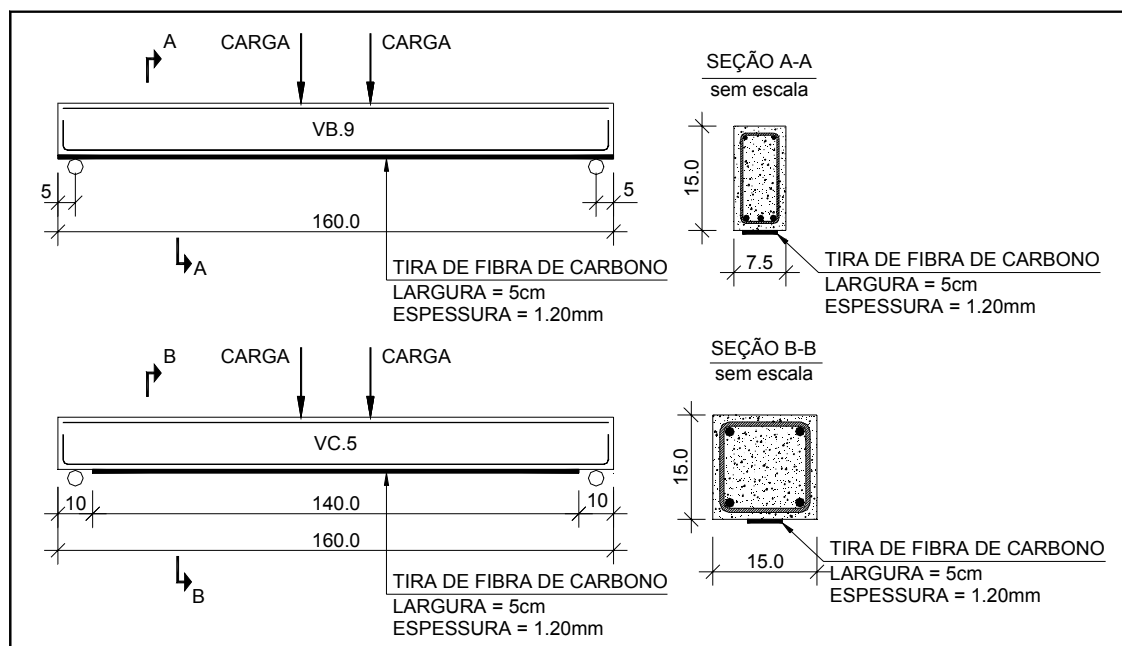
Disposição do reforço das vigas VB.9 e VC.5
